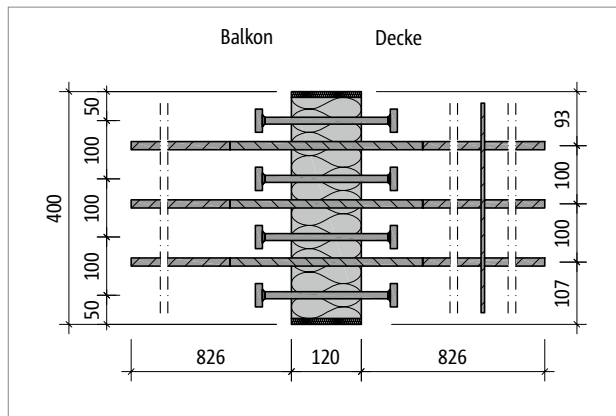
Schöck Isokorb® XT Typ QP-V8: Produktgrundriss
